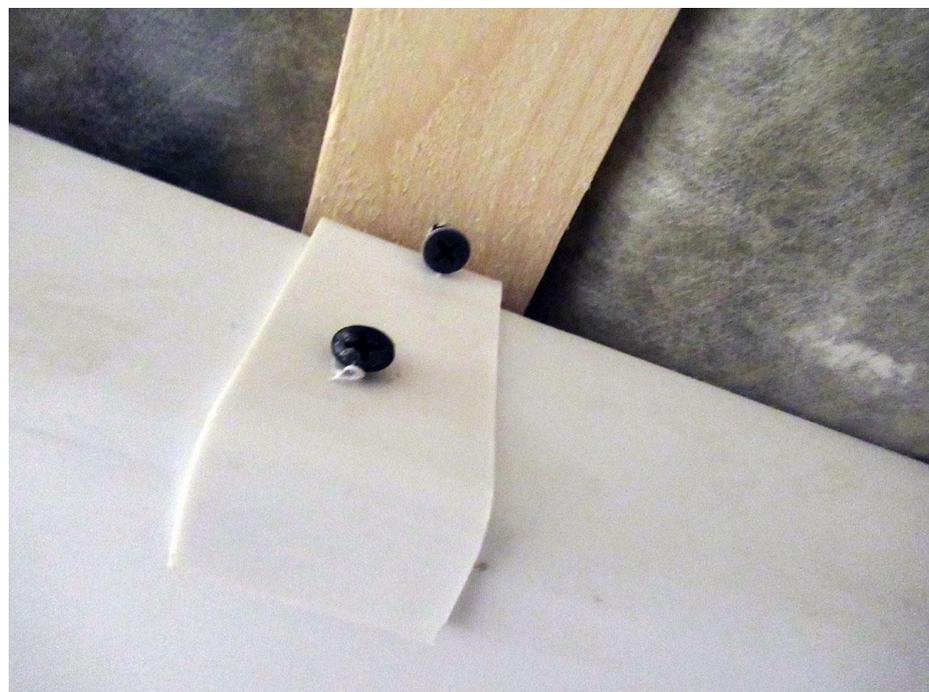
Дефекты крепления воздуховодов системы вентиляции
